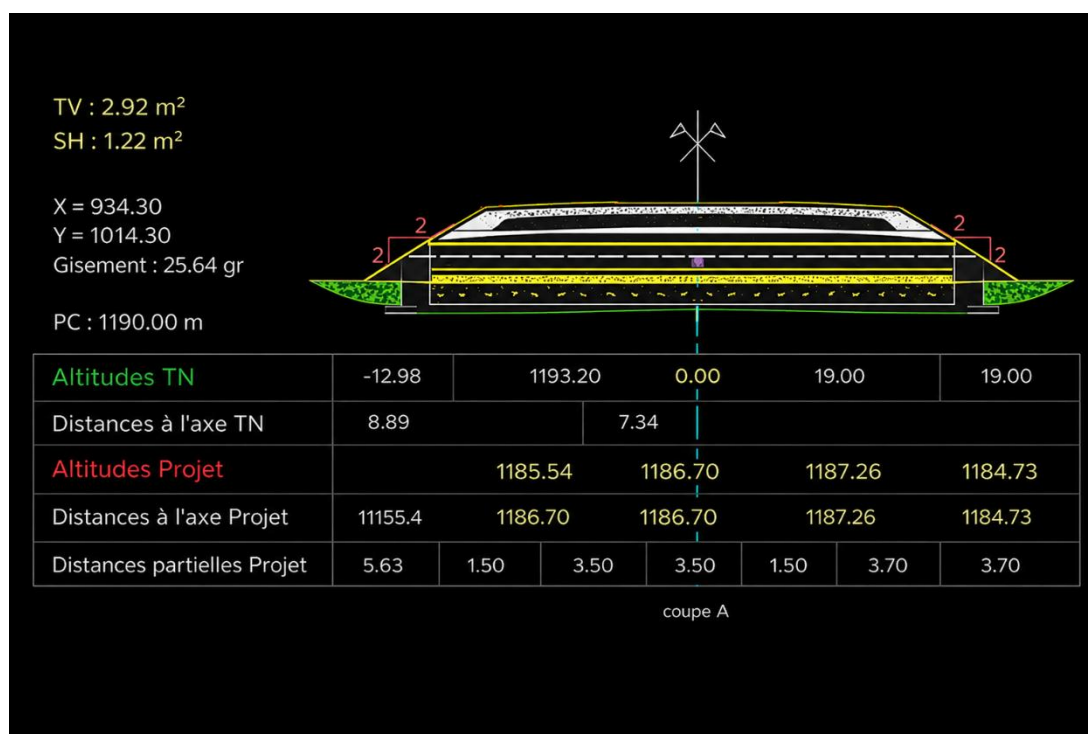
9 - - Profil en travers types ouvrage hydraulique
